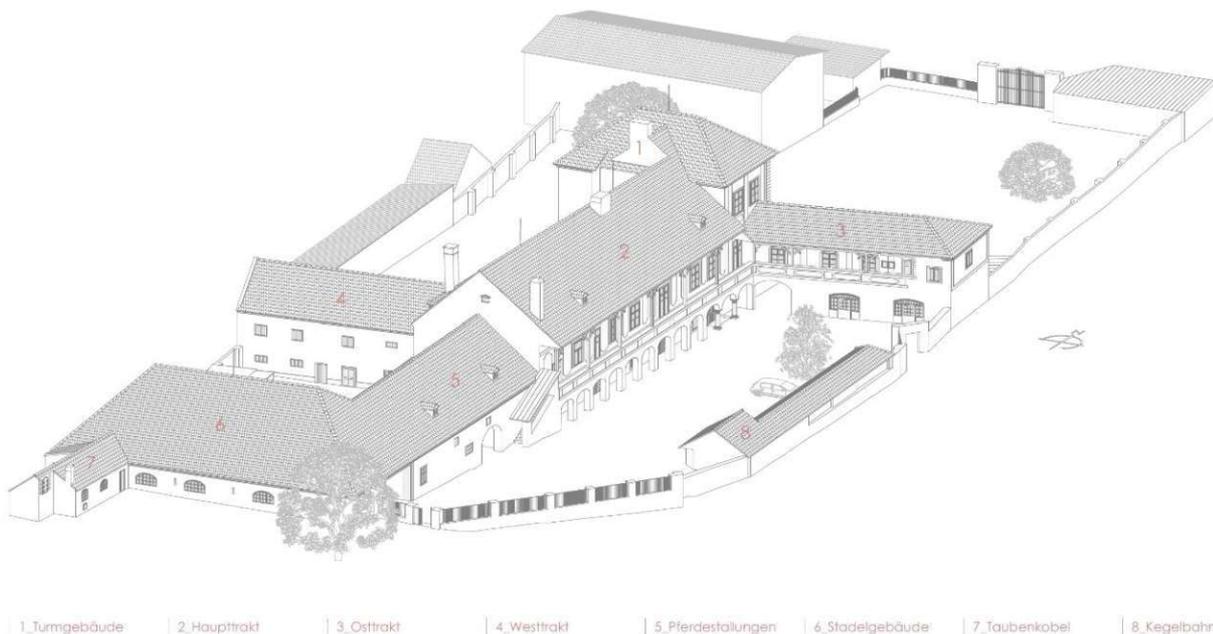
Axonometrie Bestandsgebäude Nordwest
